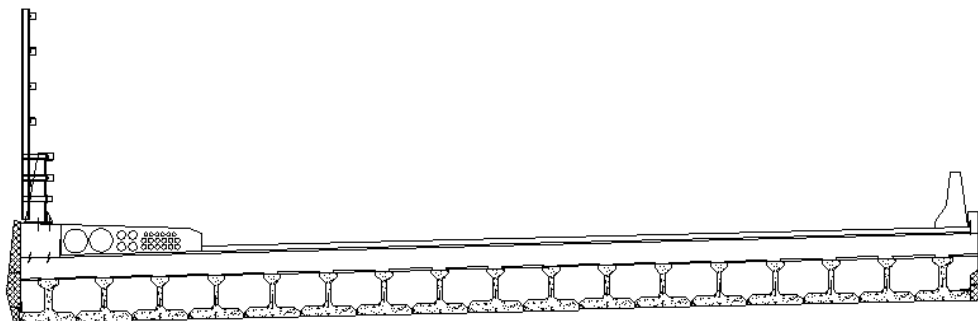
Coupe transversale du pont Pinel avec poutres ITE®
